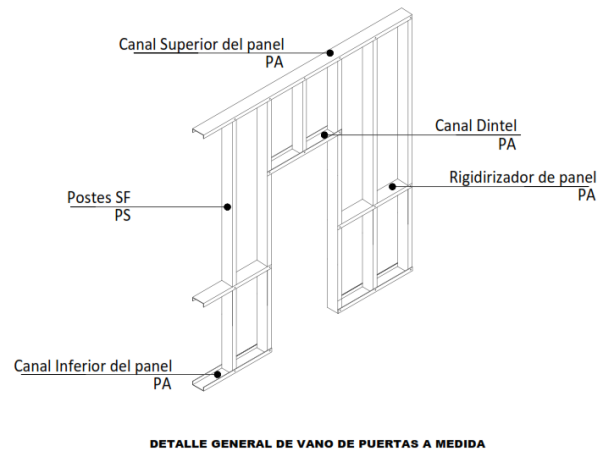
, Proceso de armado canal dintel. (Fuente: propia del autor)
